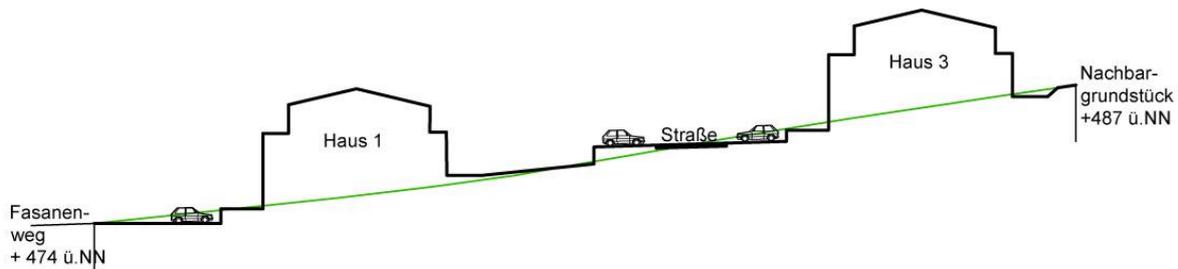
Schemaschnitt mit geplanter Bebauung (grün = Urgelände)
